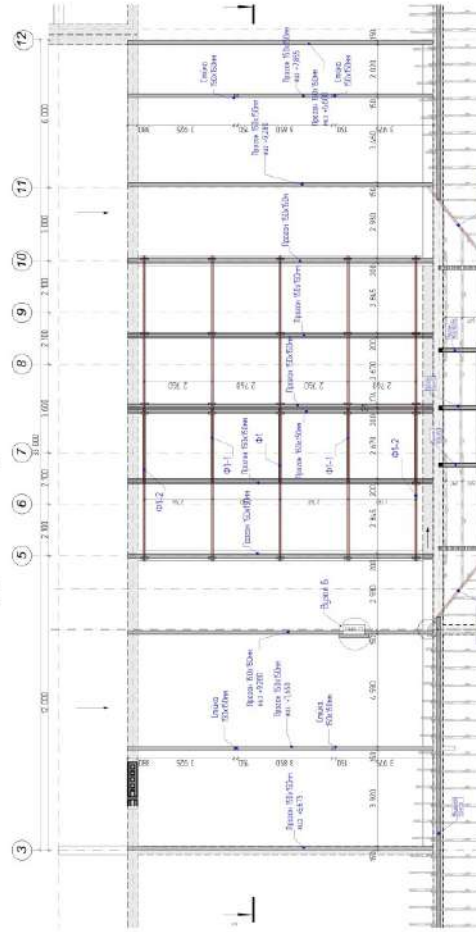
План влаштування металевих ферм для даху блоку Б-2
